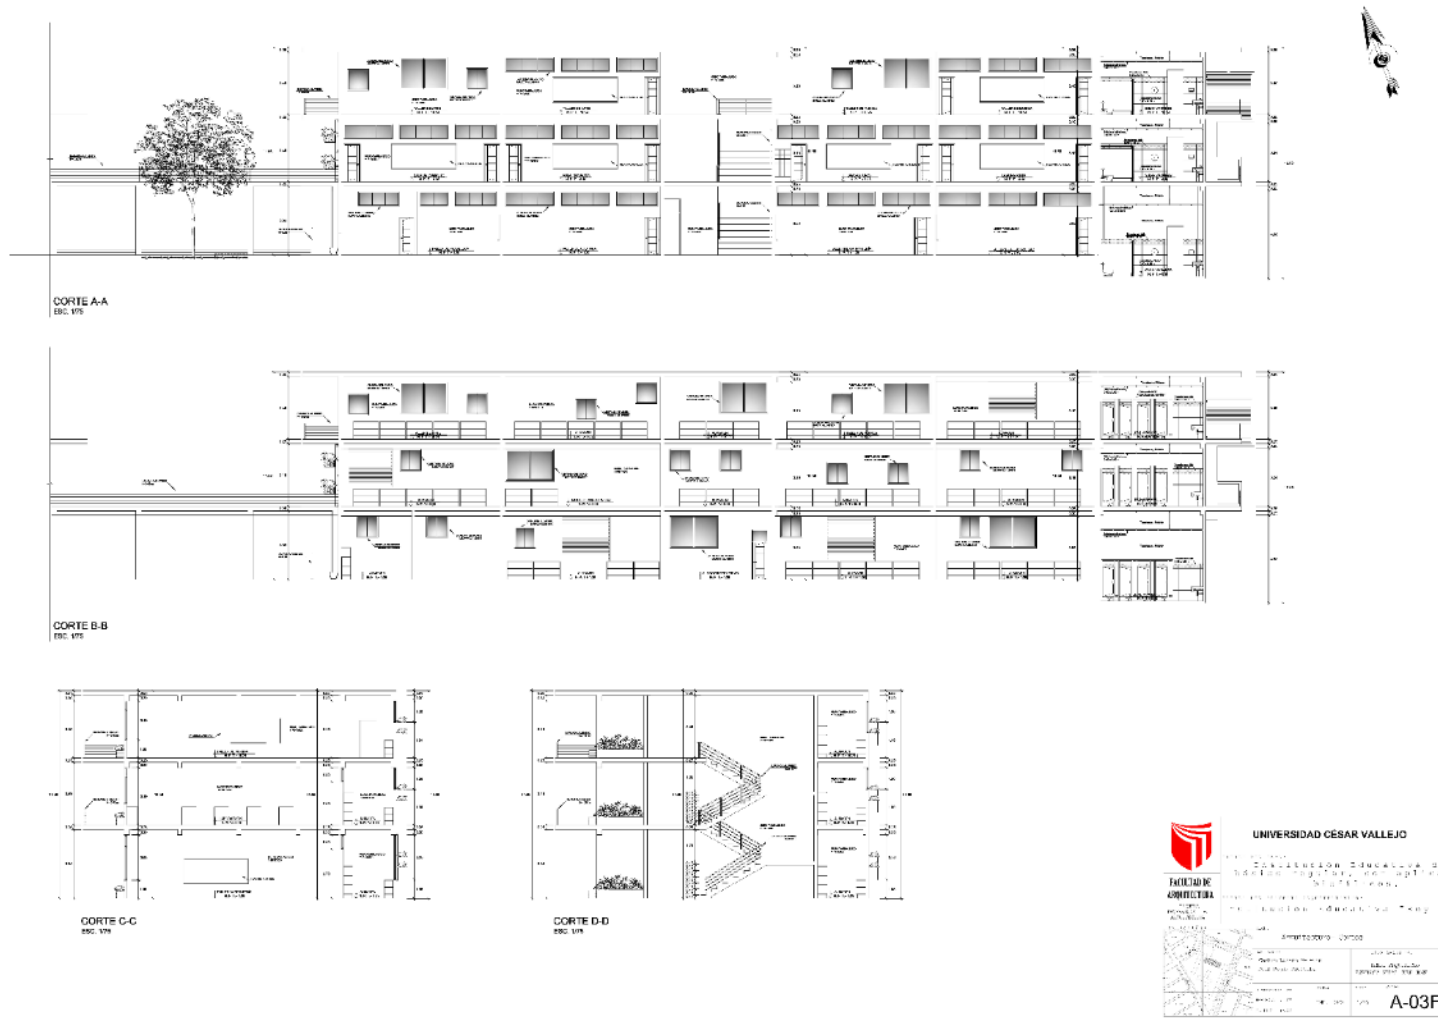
Plano de cortes "F", Fuente: elaboración propia
